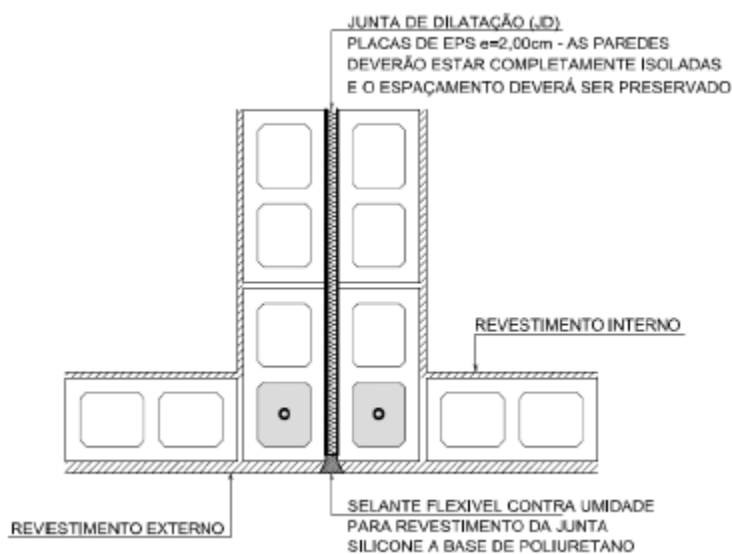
Junta de Dilatação - Laje de Cobertura (Detalhe em planta)
